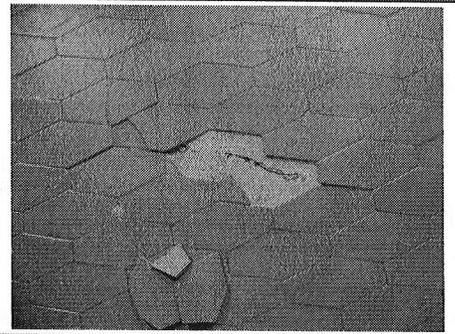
Grietas en muro divisorio al interior de la vivienda ubicada en la Carrera 73 No. 66A-02 Sur.
